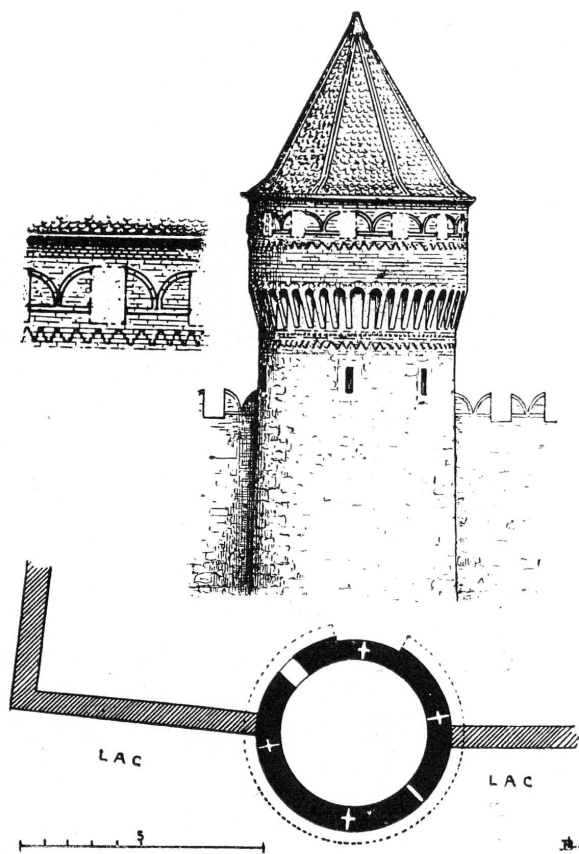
Plan et élévation de la Tour-Maitresse.
